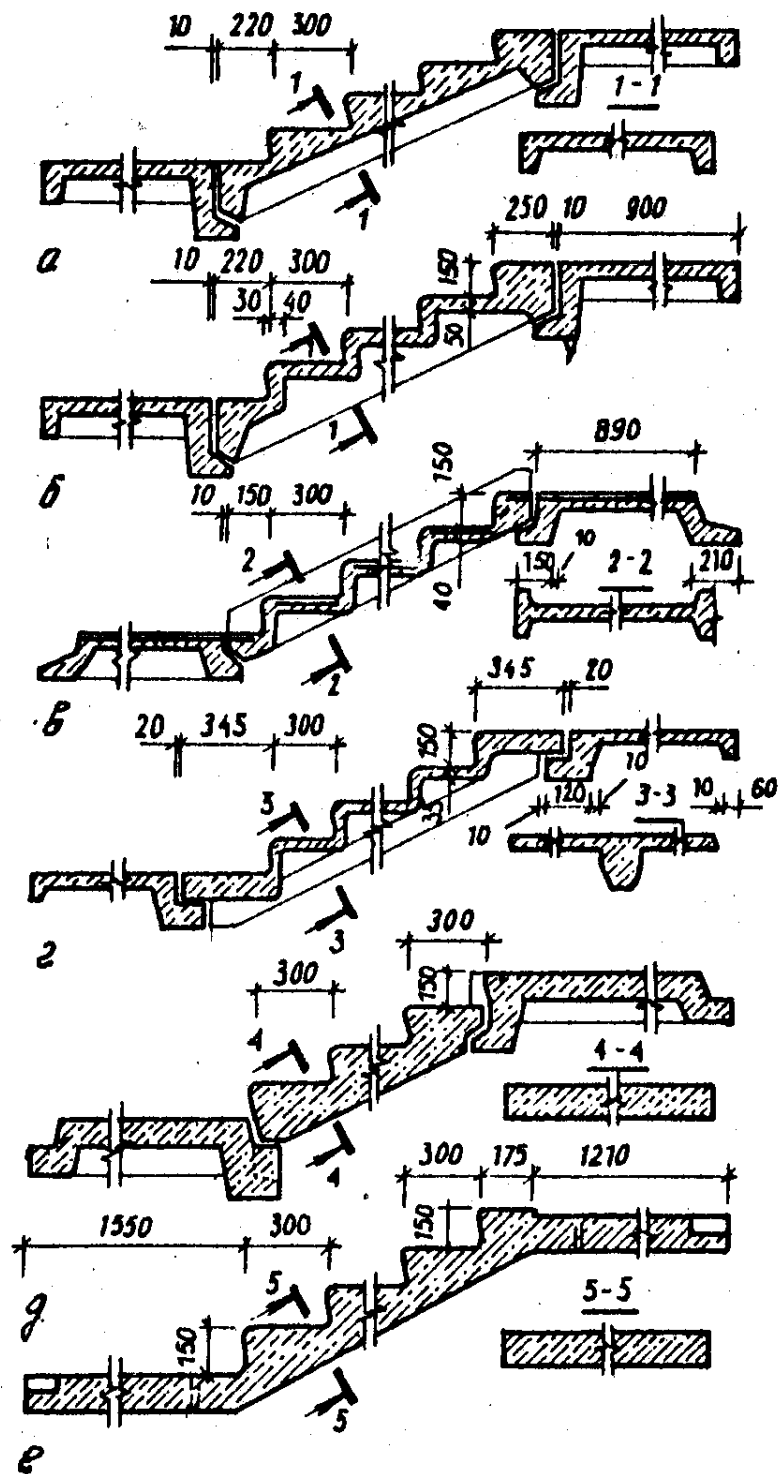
Конструктивне вирішення залізобетонних повнозбірних сходів:
